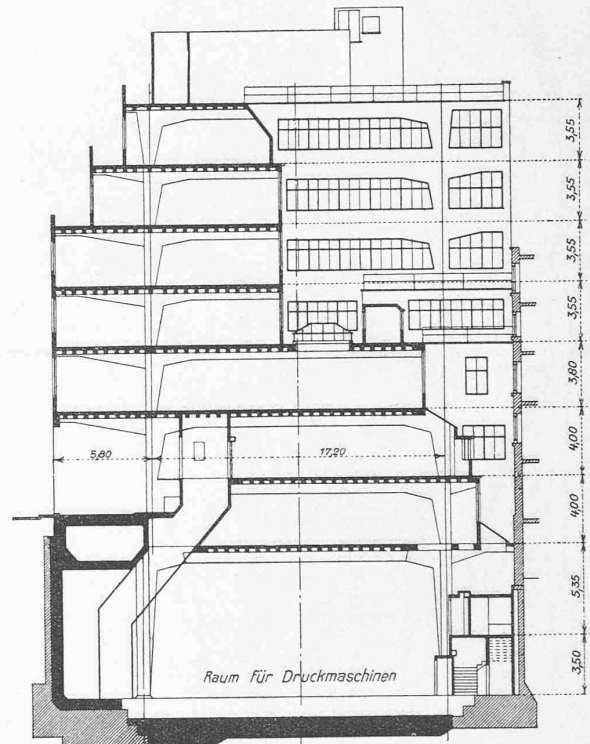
Eisenbetonkonstruktion des Zeitungsgebäudes „Daily-Express“. Querschnitt 1 : 400. — Links „Shoe Lane“ mit Wagenzufahrt.
